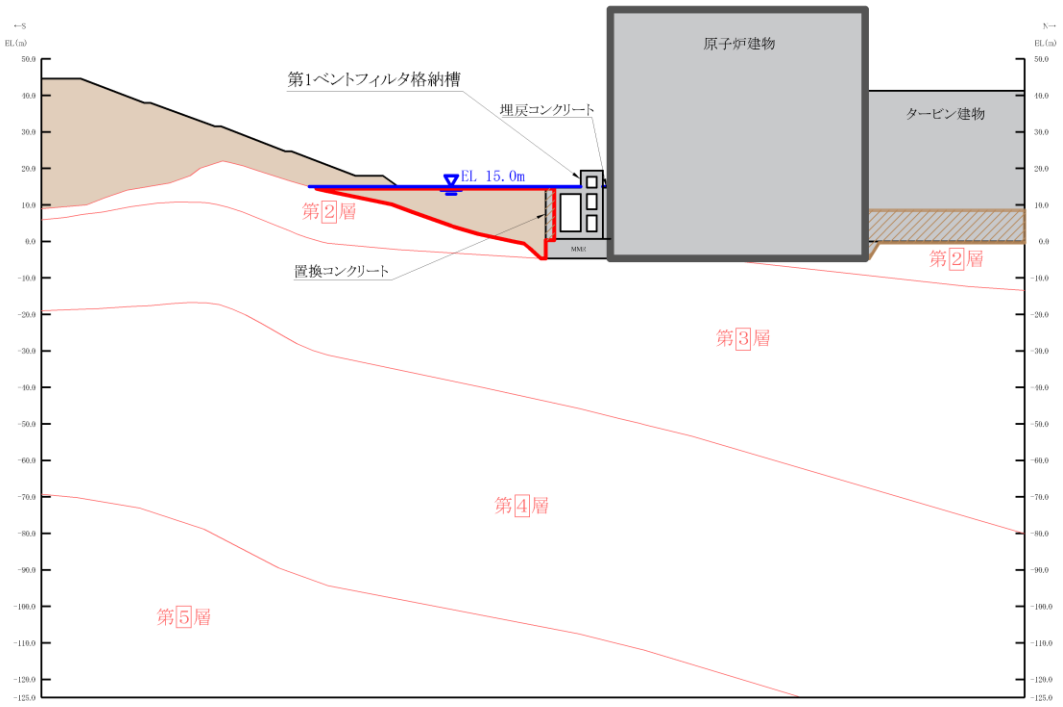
第 1 ベントフィルタ格納槽 評価対象断面図 (A-A 断面)
